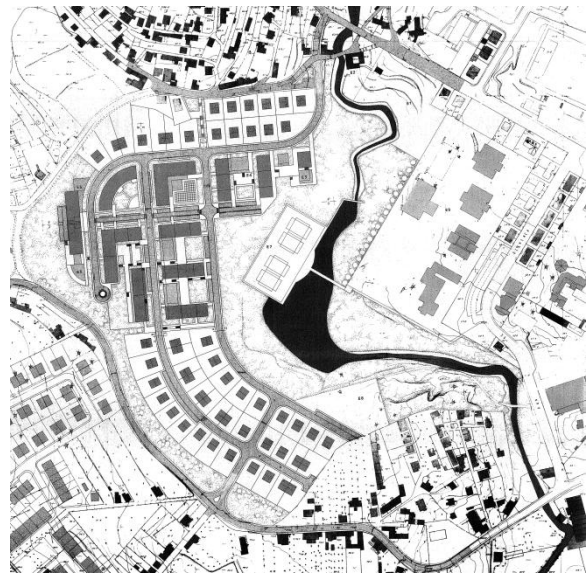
Planta Geral do Plano de Pormenor da Quinta de Geão (Anexo VI)
